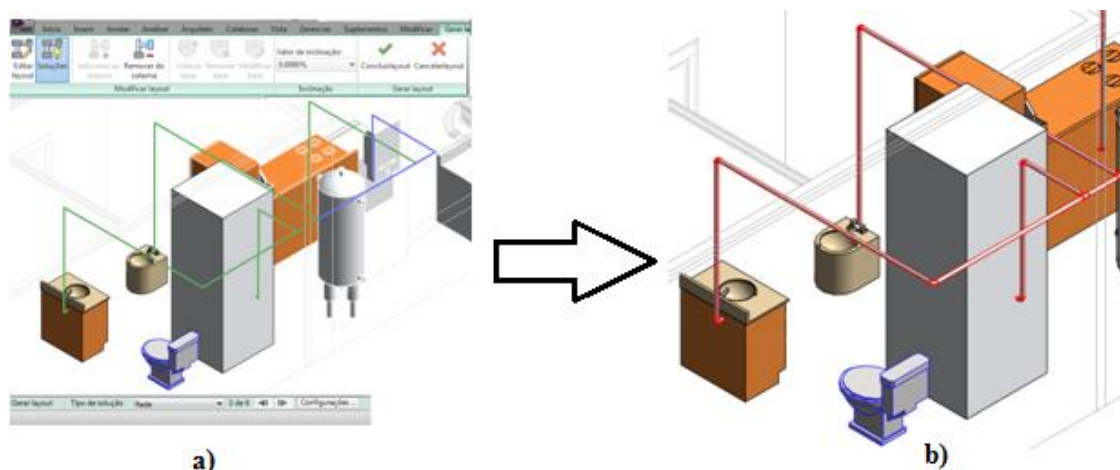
Exemplo de traçado do sistema: a) traçado automático proposto; b) correspondente resultado final
